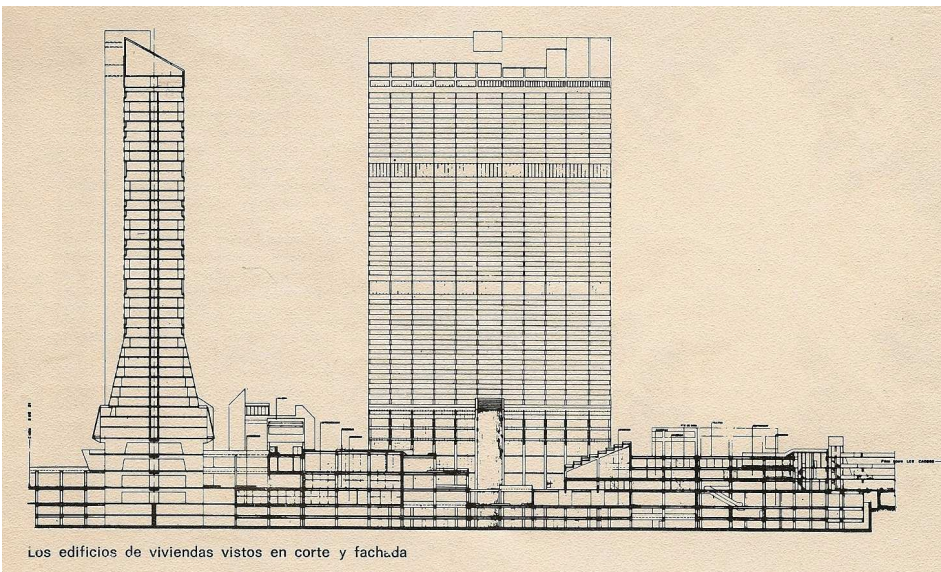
Proyecto de Bloques de viviendas de Parque Central.
